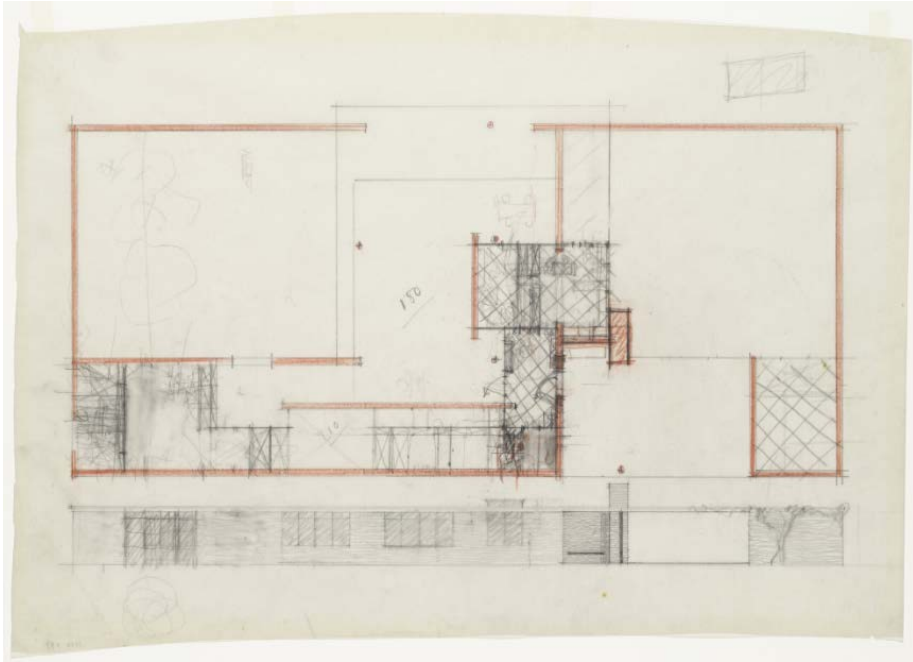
Estudo de planta baixa e elevação, Casa Lange, 1935
